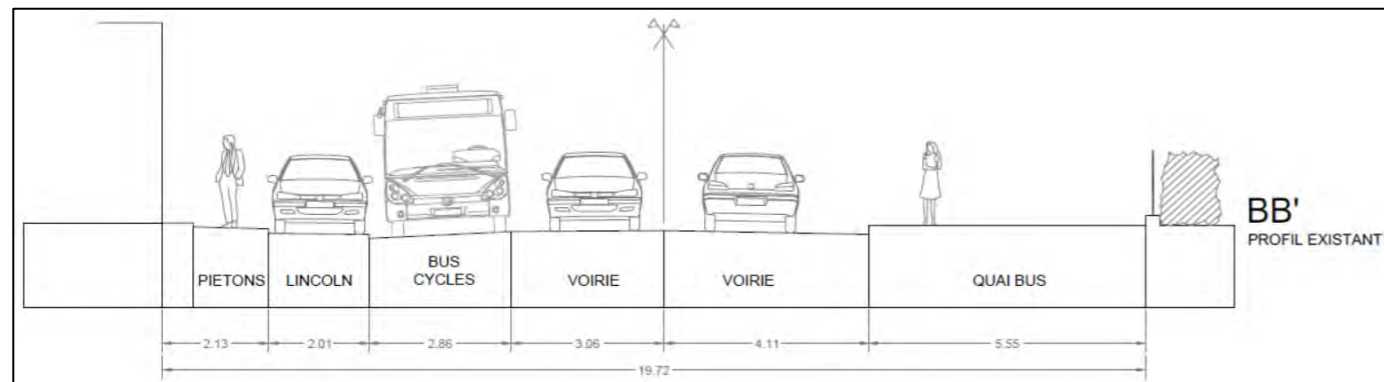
Profil en travers type existant entre l'allée des Platanes et la rue de la Clairière
